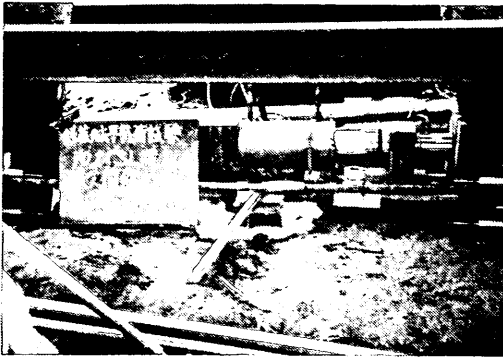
水平交番載荷(正荷重: 押開き)
